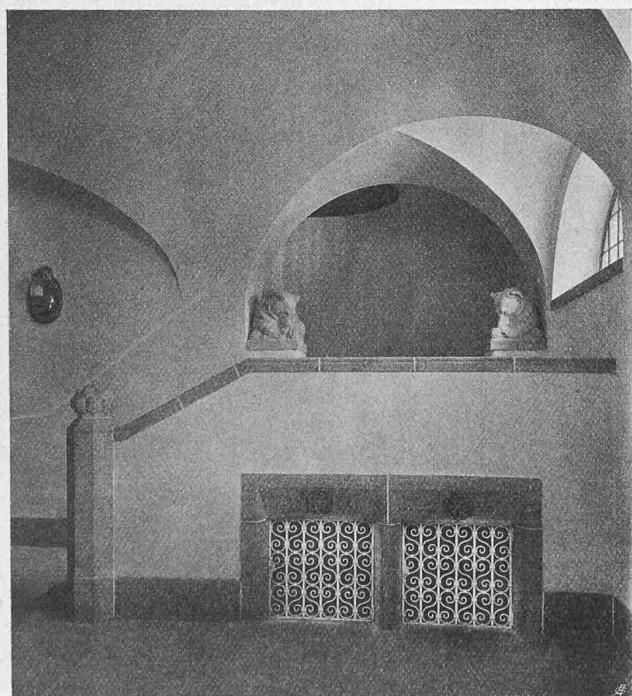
Treppe in der Erdgeschoss-Vorhalle.
